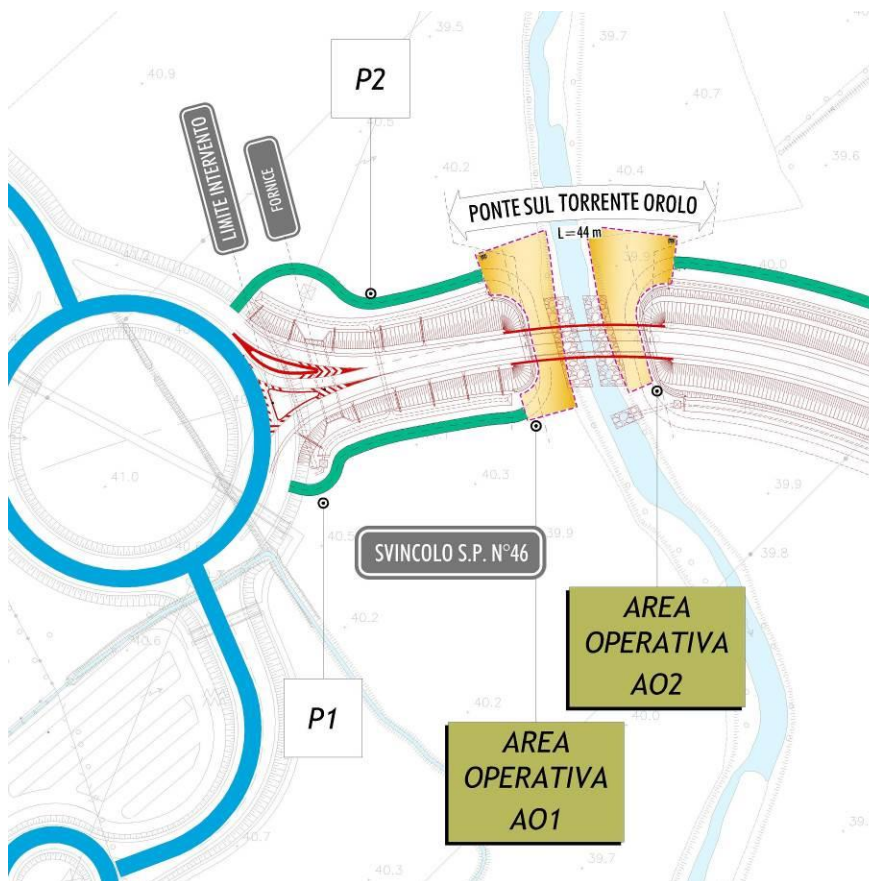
STRALCIO PLANIMETRICO DELLE PISTE P1 E P2
